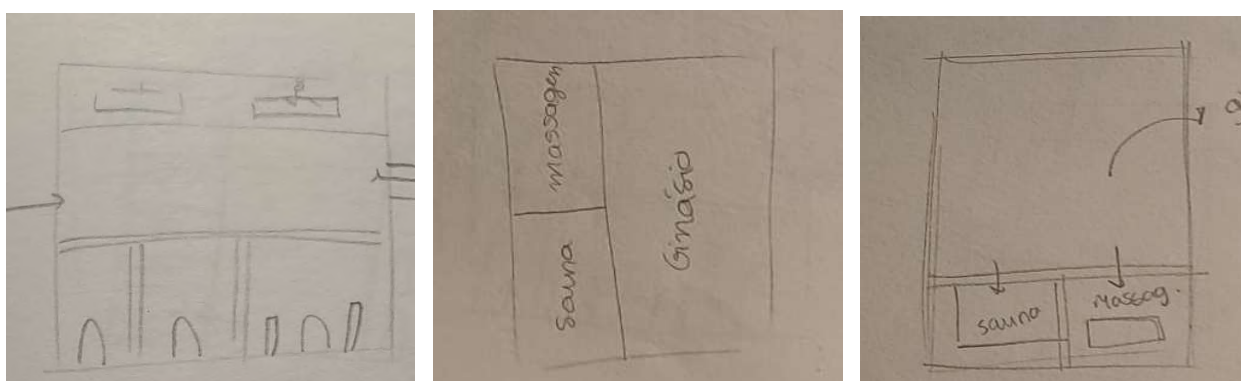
Estudo dos Layouts do Piso 0, I.S e Ginásio - Fonte: Bruna Monteiro
